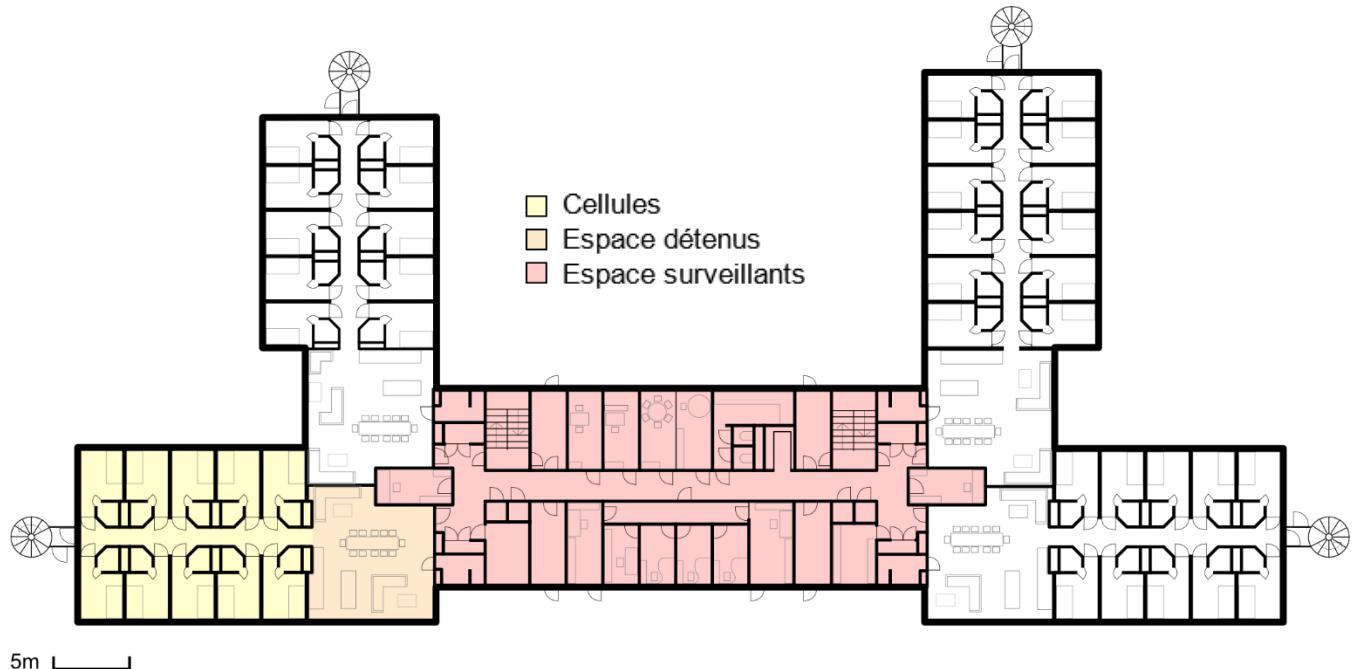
Plan du rez-de-chaussée du bâtiment 4a
